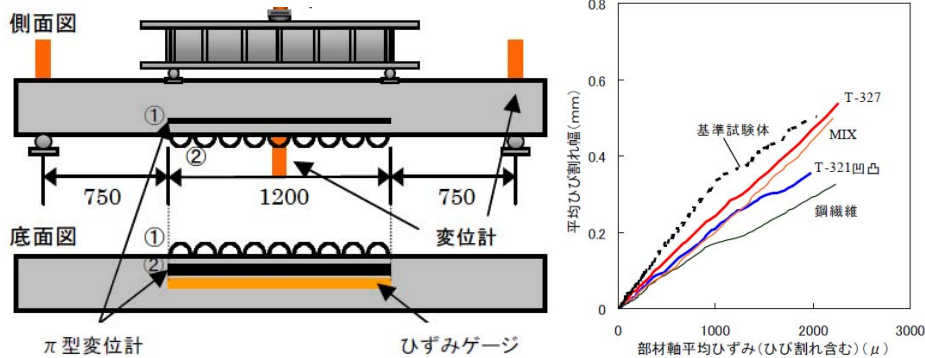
各種繊維を混入した鉄筋コンクリート部材の平均ひび割れ幅の評価¹³⁾
